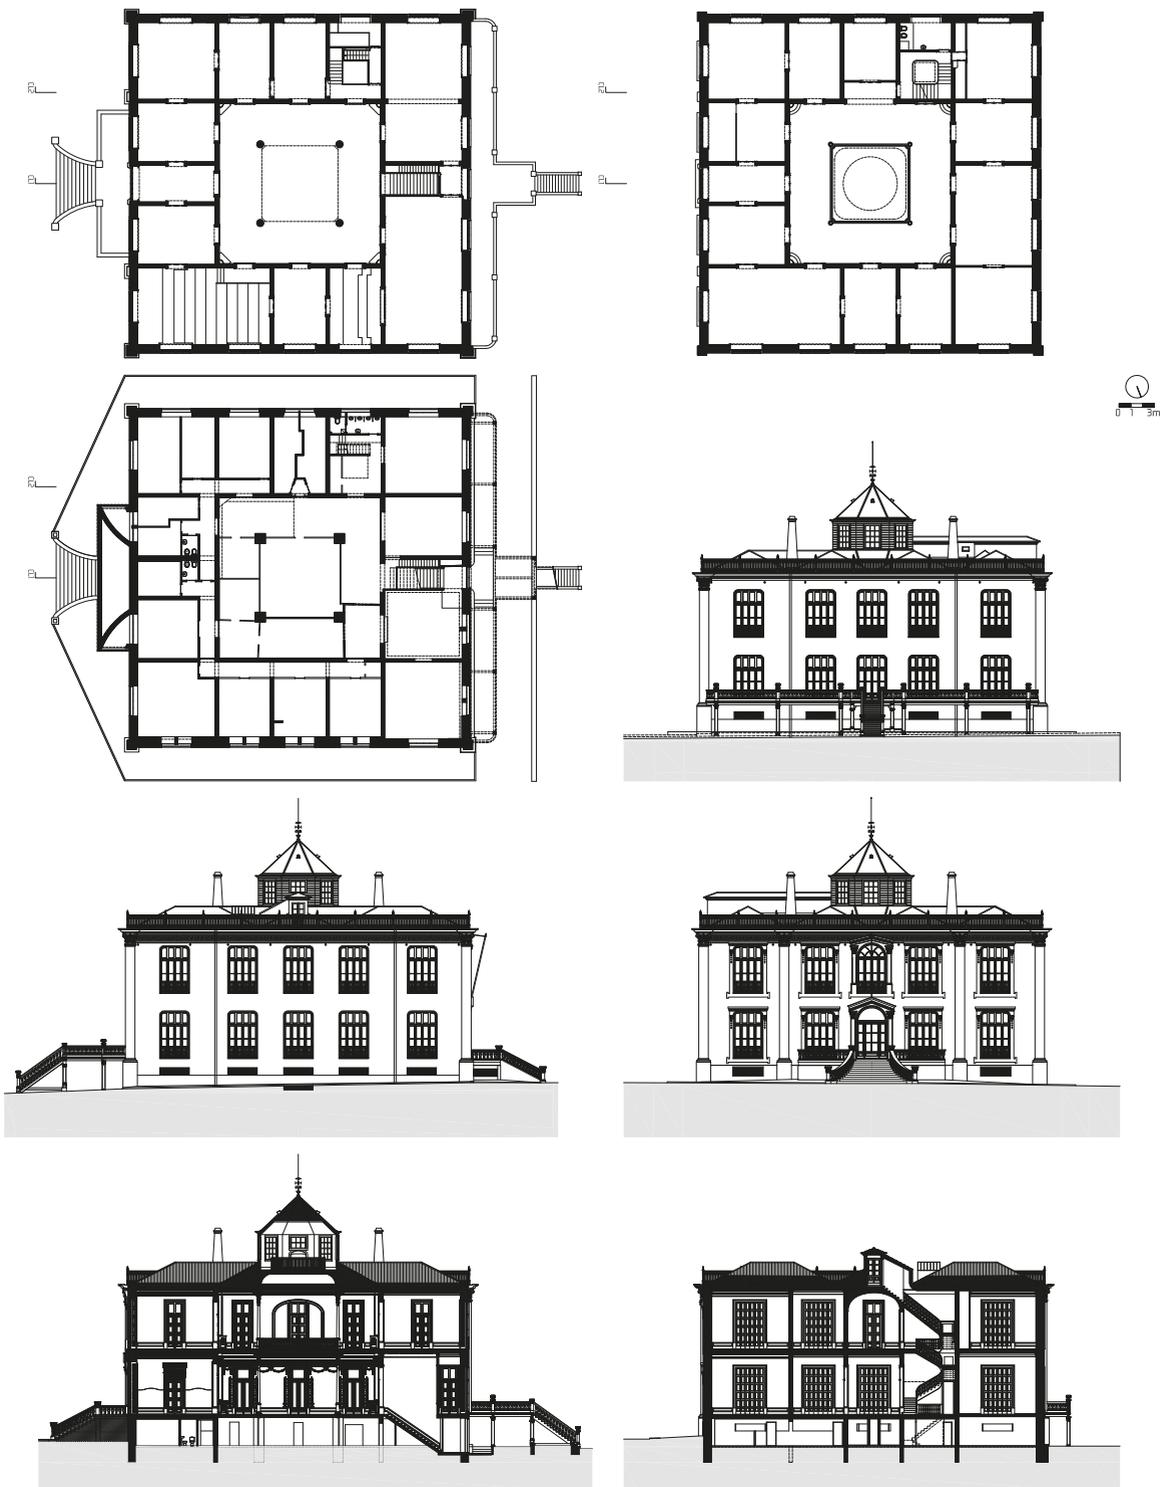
Desenhos de levantamento: plantas do rés-do-chão, 1.º andar e cave; alçados sul, poente e da rua do Campo Alegre; cortes longitudinais CL1 e CL2.
